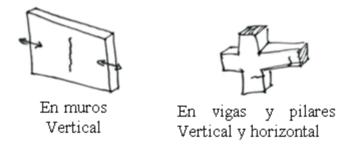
Grietas y fisuras debidas a acciones térmicas
